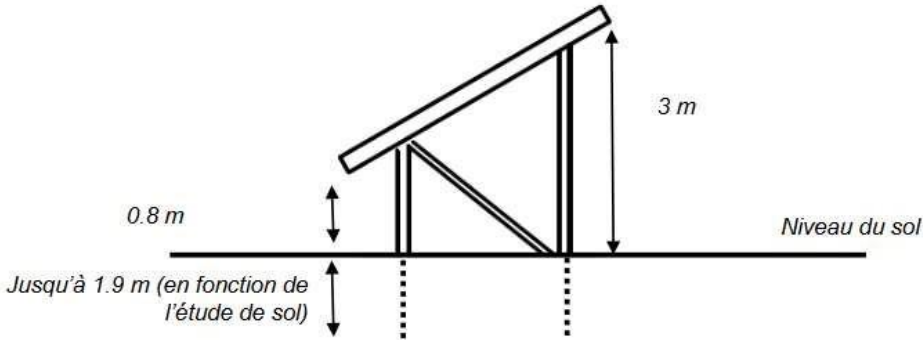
Schéma de panneaux solaires sur pieux battus (Reservoir sun).
